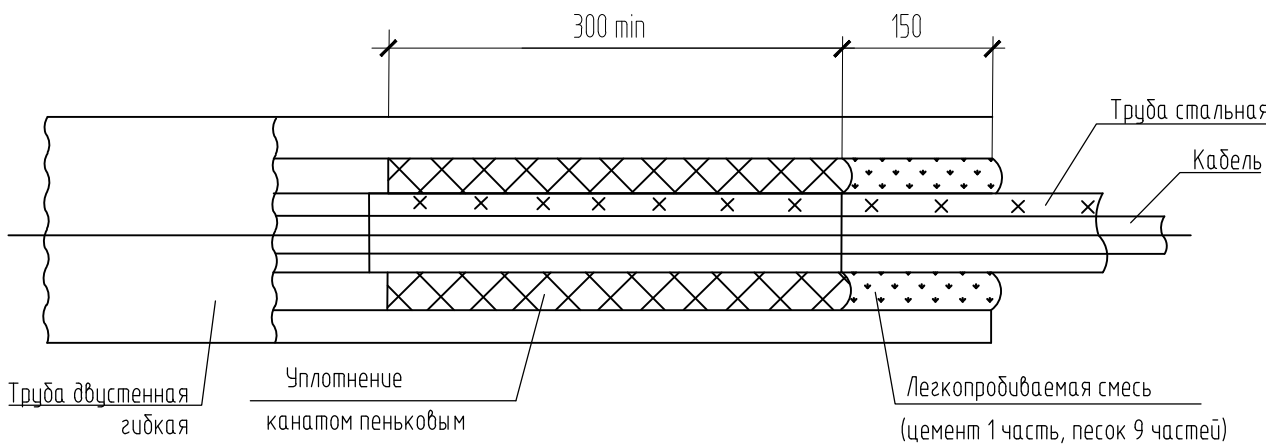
Заделка концов водогазопроводных труб после прокладки кабеля
